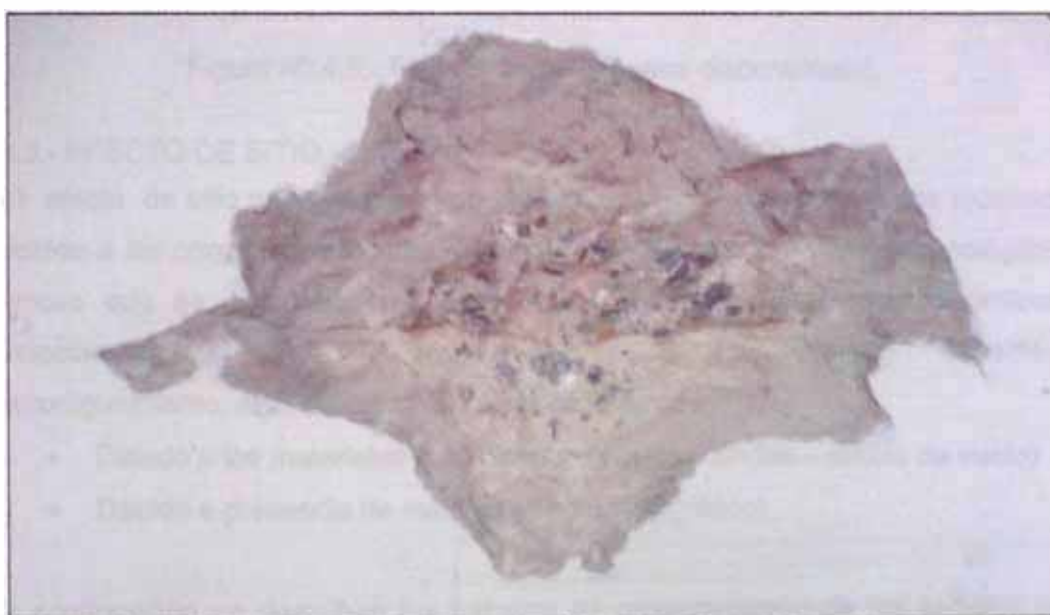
Junta de construcción en muro estructural (fisura generada por junta).
